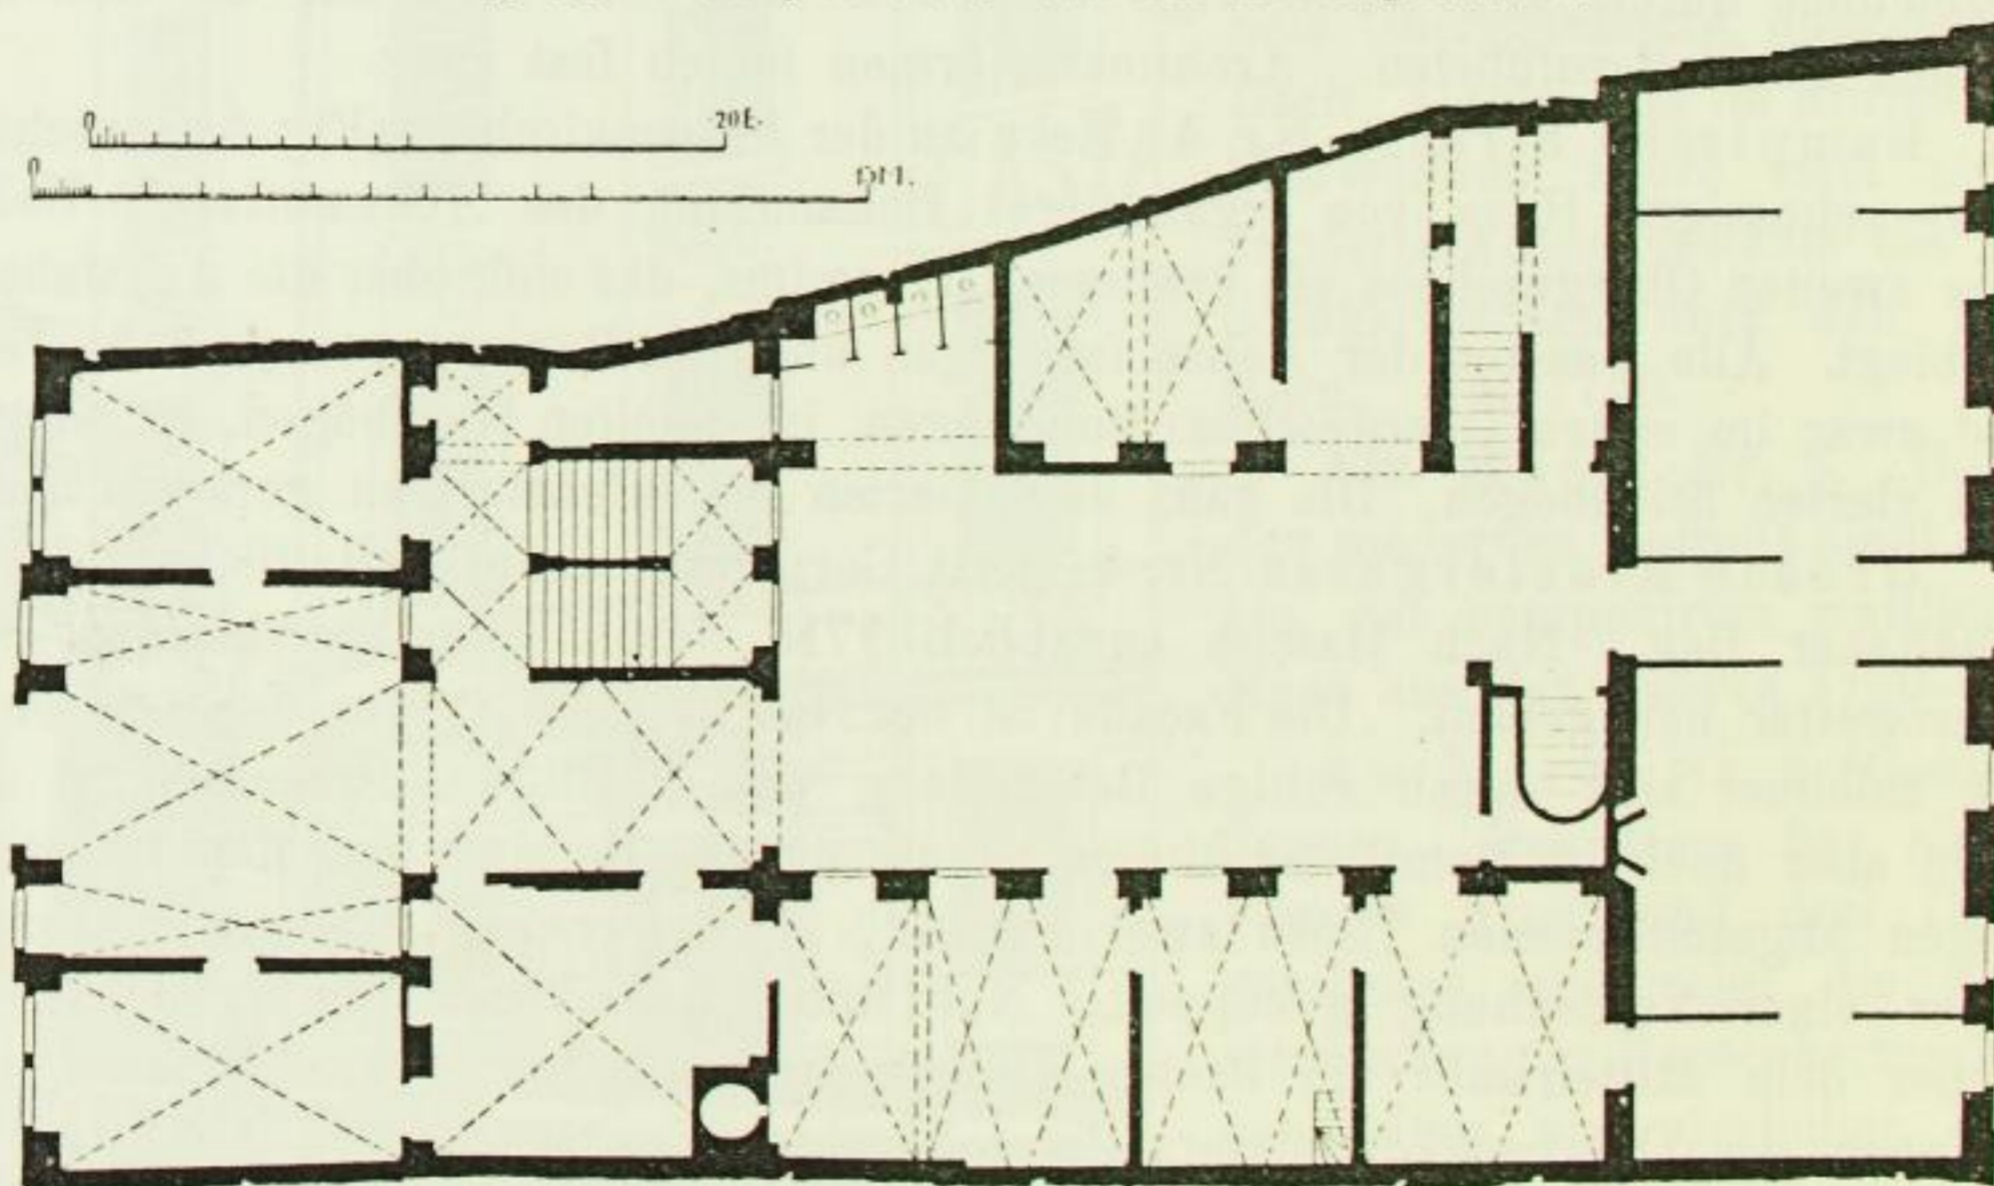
Klostergasse Nr. 4. Grundriss des Erdgeschosses.
